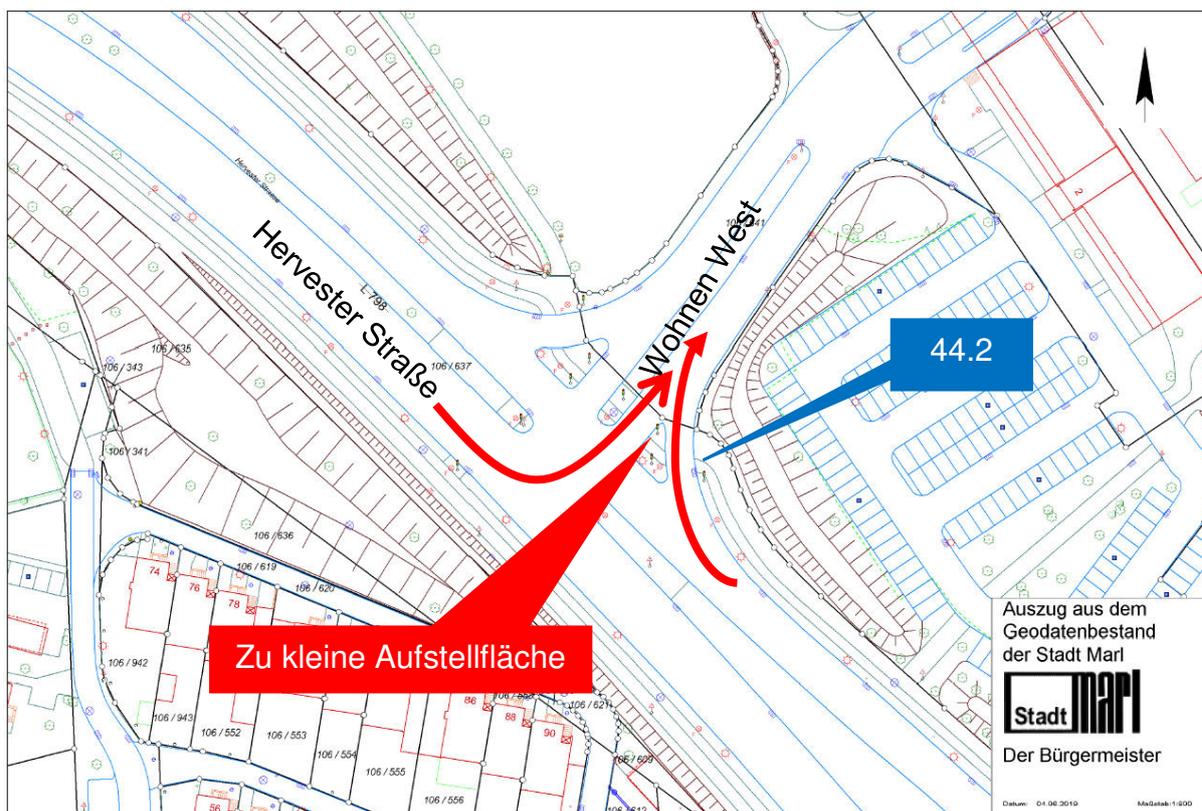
Lageplan 44.2 – Zufahrt Wohnen-West
